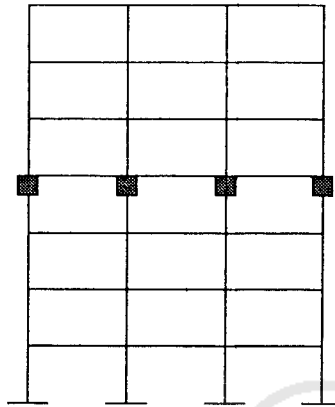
Tingkat 7 lantai ke 1
